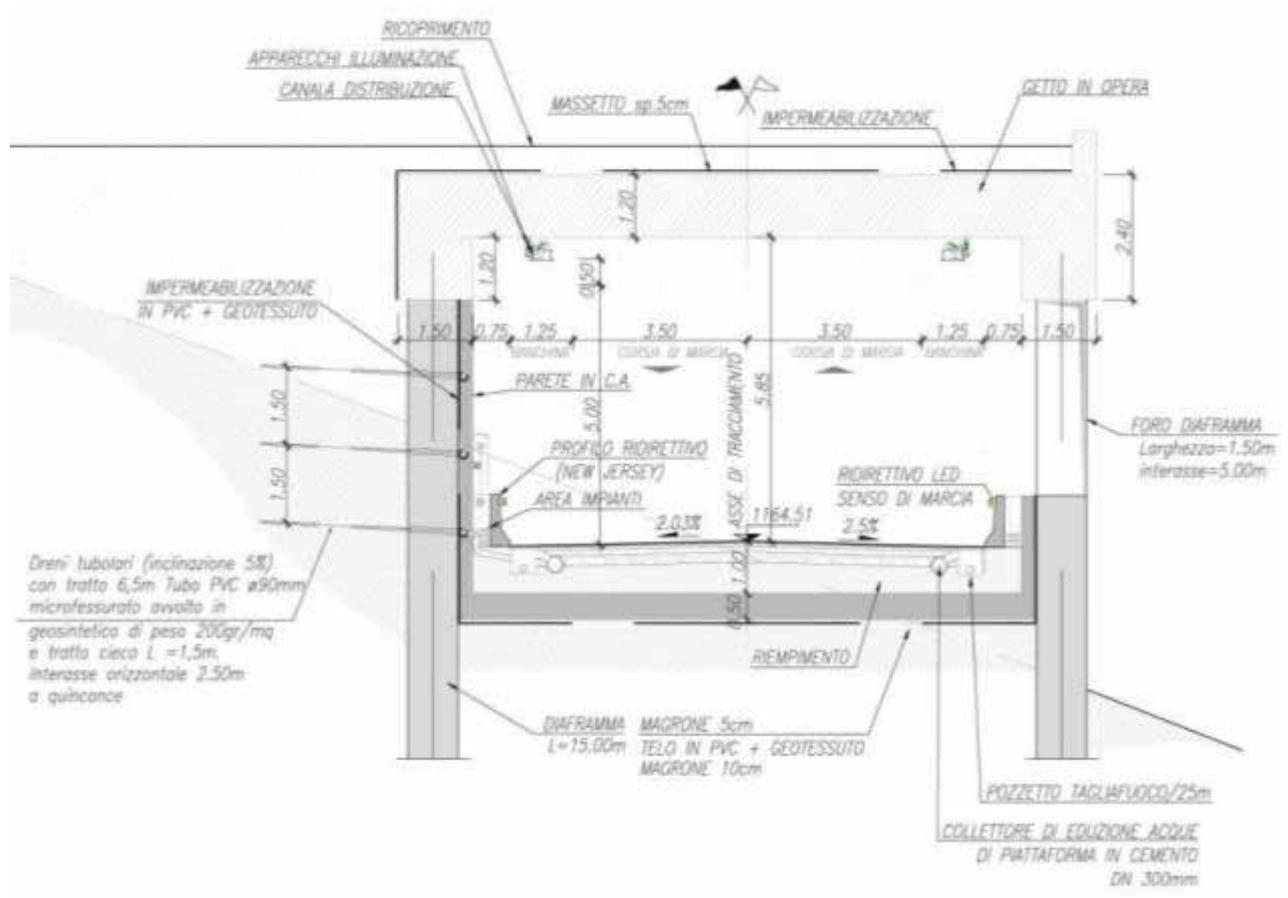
Tratto di galleria aperta (Sezione 08 - ns. elaborazione T01GA010STPF02_A_Planimetria, profilo e sezioni tav. 2/2 del progetto definitivo).
